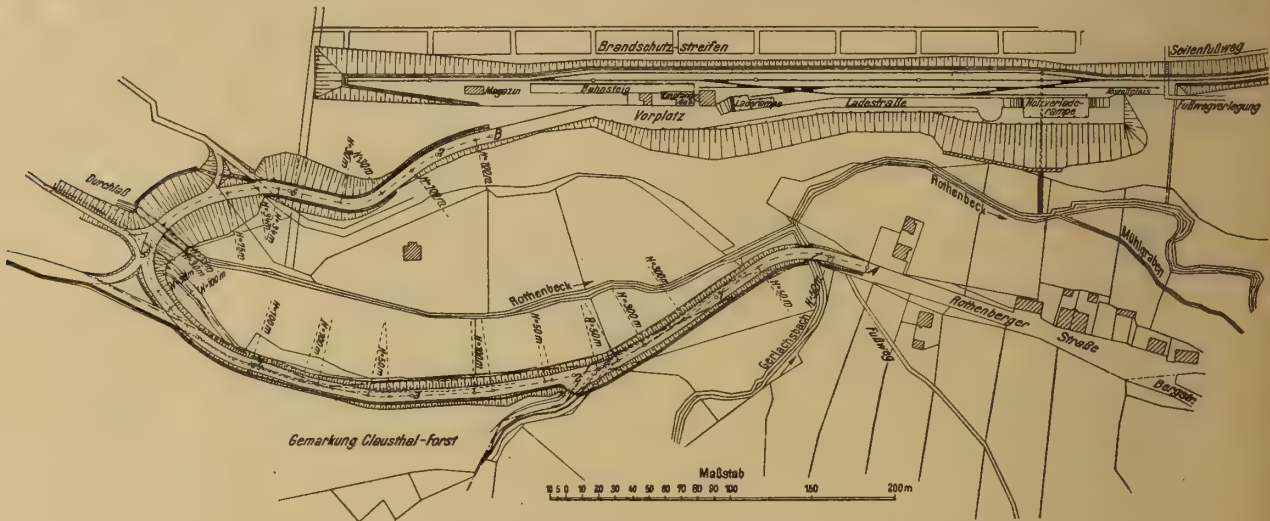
Lageplan des Bahnhofs Altenau nebst Zufuhrstraße
